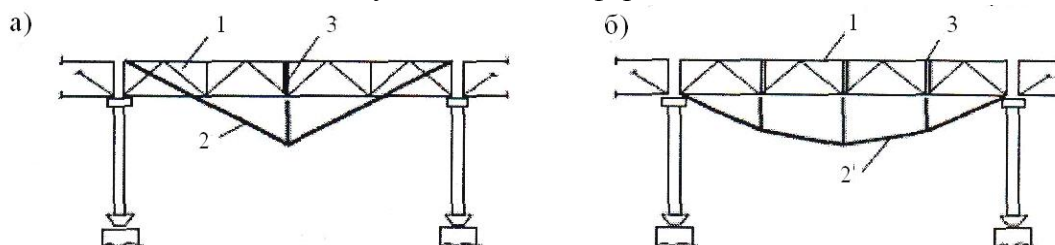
Усиление стропильных ферм путем установки шпренгельных систем:
